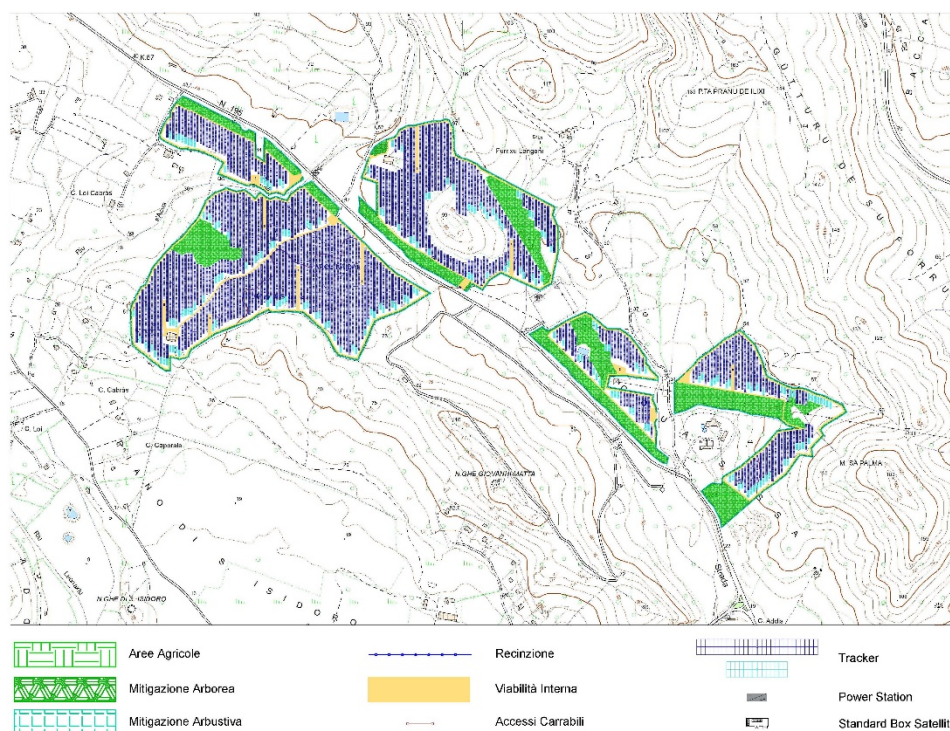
Layout dell'area d'impianto ricadente sul territorio di Teulada (SU) su C.T.R.
